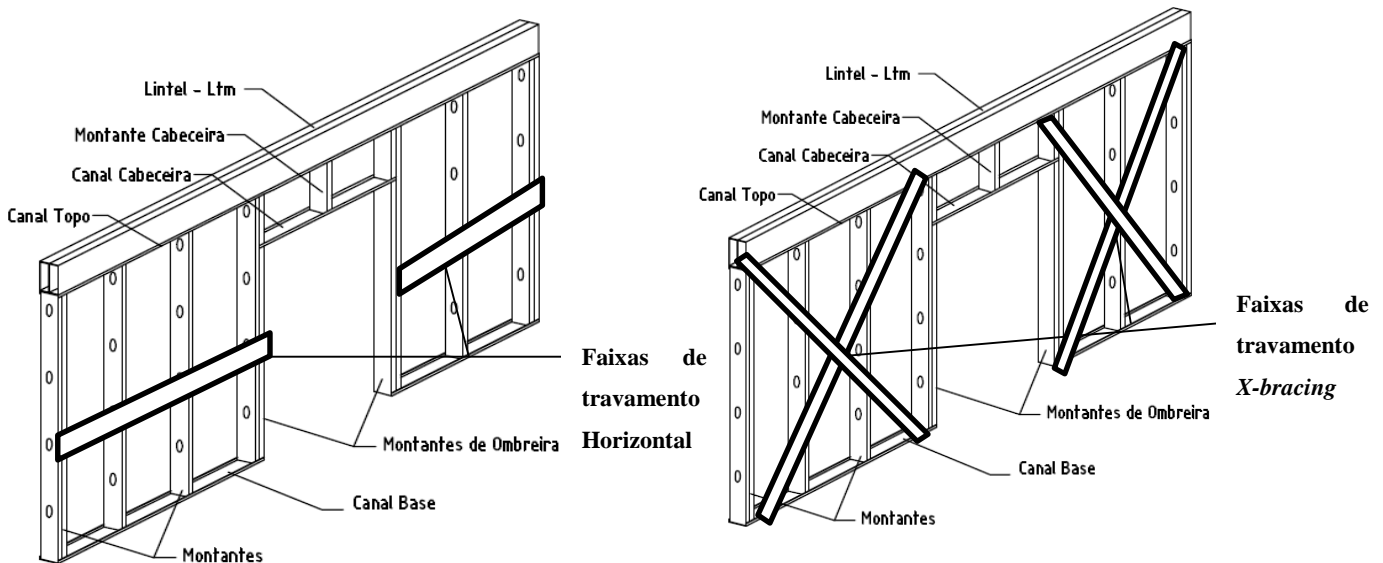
Pormenor tipo de aplicação de faixas de travamento mais comuns
